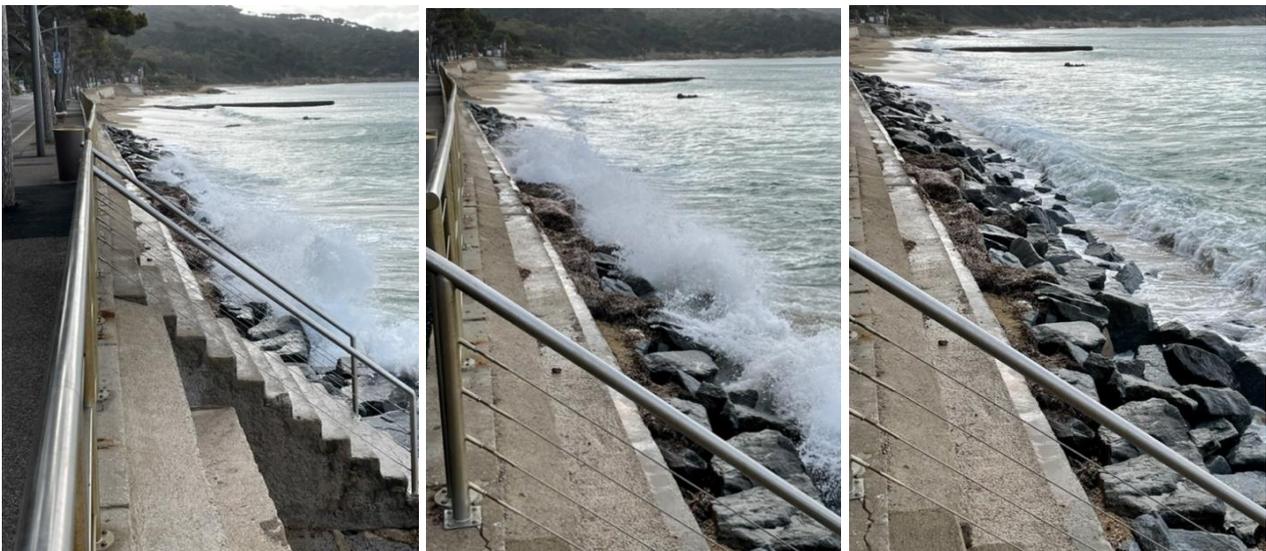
Impact de la houle sur le mur existant et notamment ses fondations
